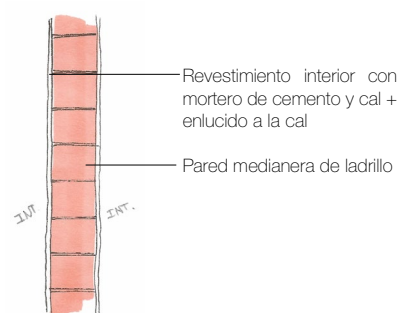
Detalle en sección de la pared medianera (autoría propia).
